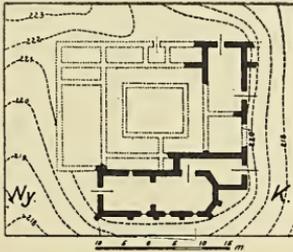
Grundriss des Pauliner-Klosters und Kirche von Salföld.
